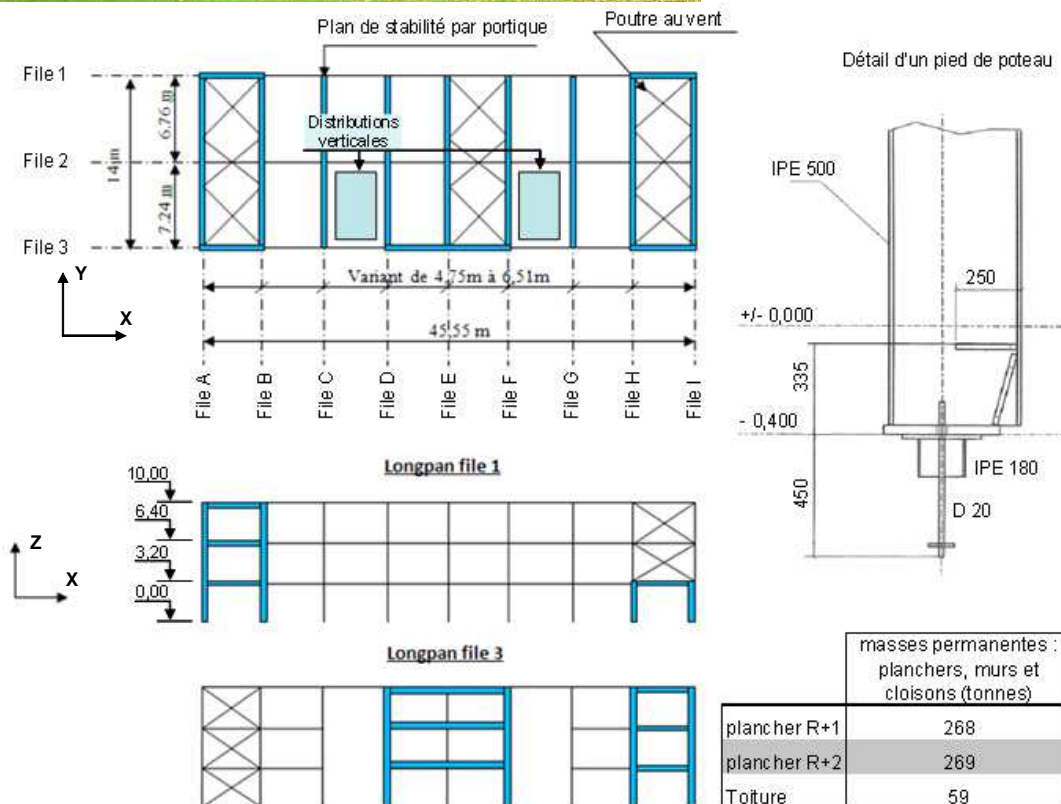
Plans et coupes généraux de la structure porteuse du bâtiment existant
